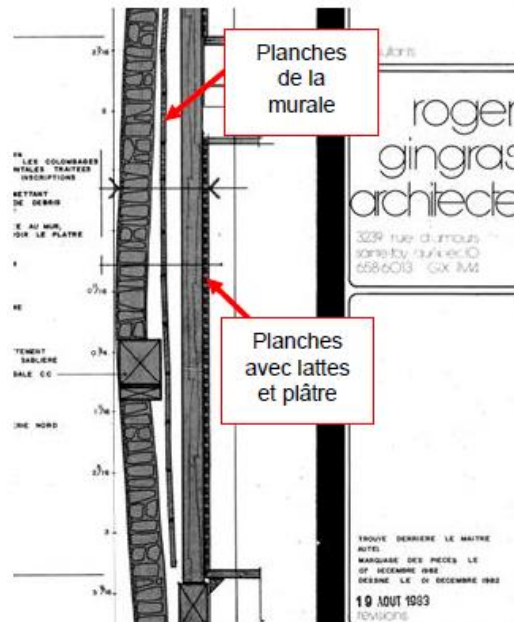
coupe provenant d'un plan d'architecte de 1983, montrant le mur en question, avant le démontage et le remontage des murs
